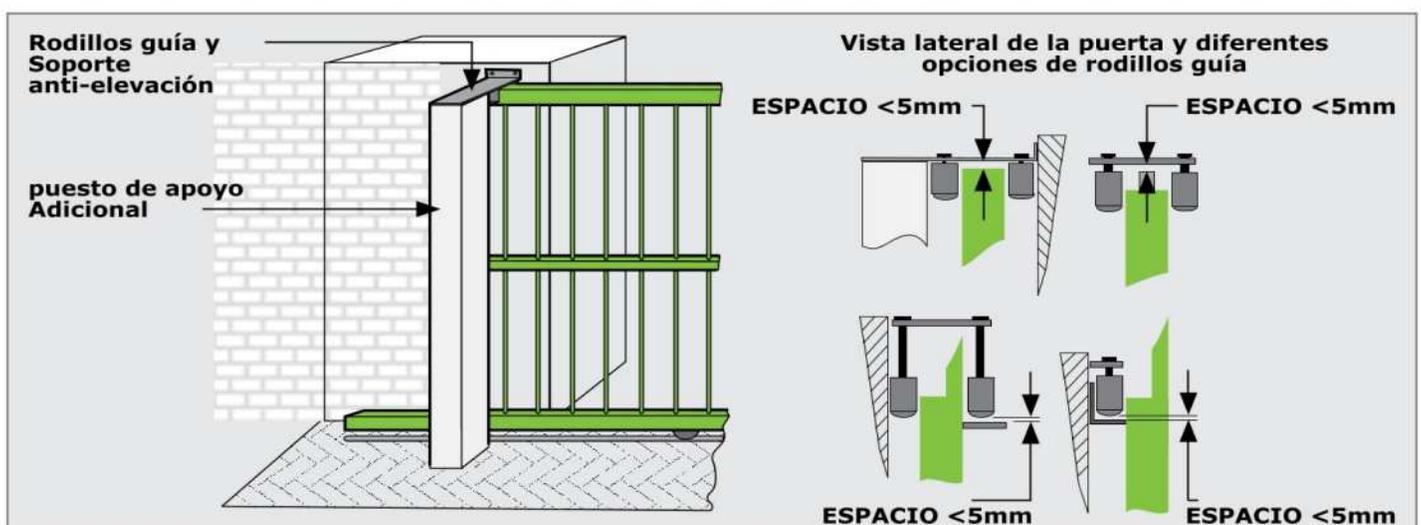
MONTAJE DE RODILLOS GUÍA
